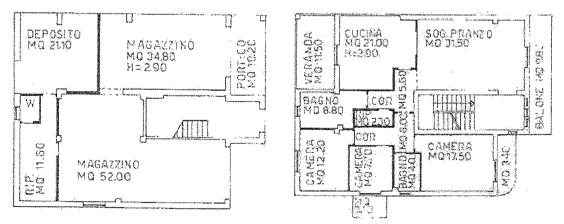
Planimetrie catastali (P.T. e P.1°) in atti ma difformi rispetto all'effettivo stato dei luoghi
